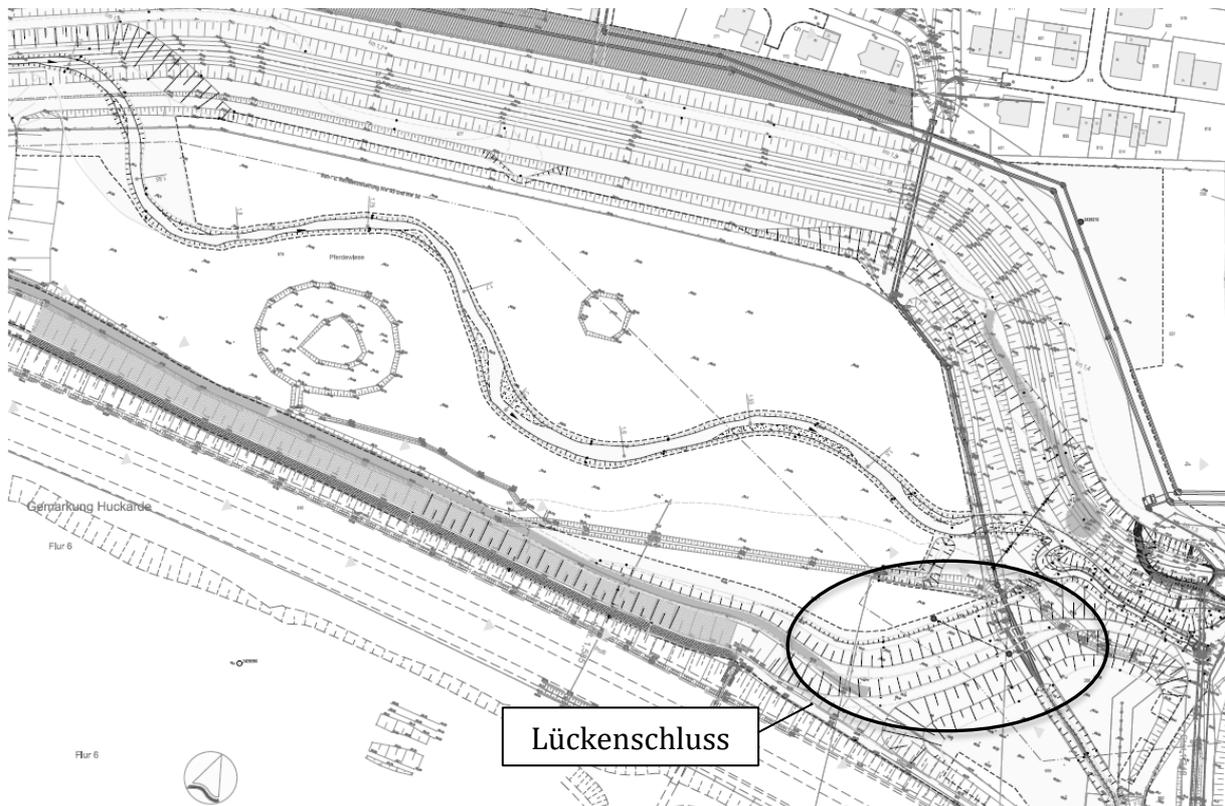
Retentionsfläche Wischlingen mit Lückenschluss
